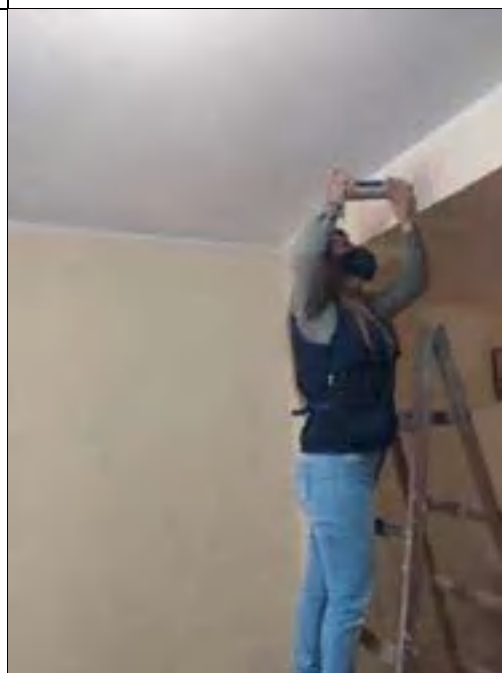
Ensayo de esclerometría en viga de Edificación 2.
